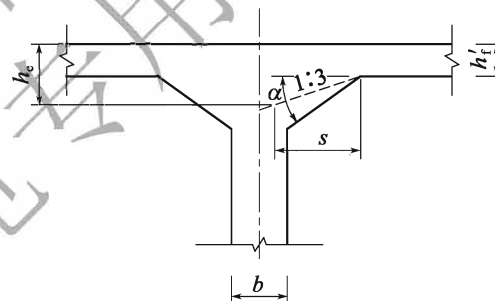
Epaisseur de calcul de la dalle en encorbellement au niveau du gousset
